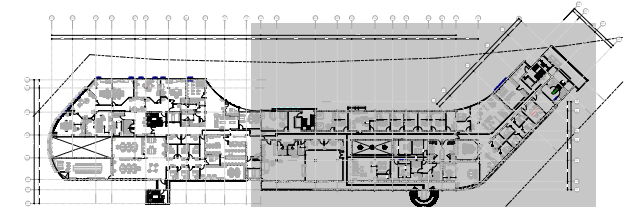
Planta de distribución arquitectónica nivel +4.00 m
